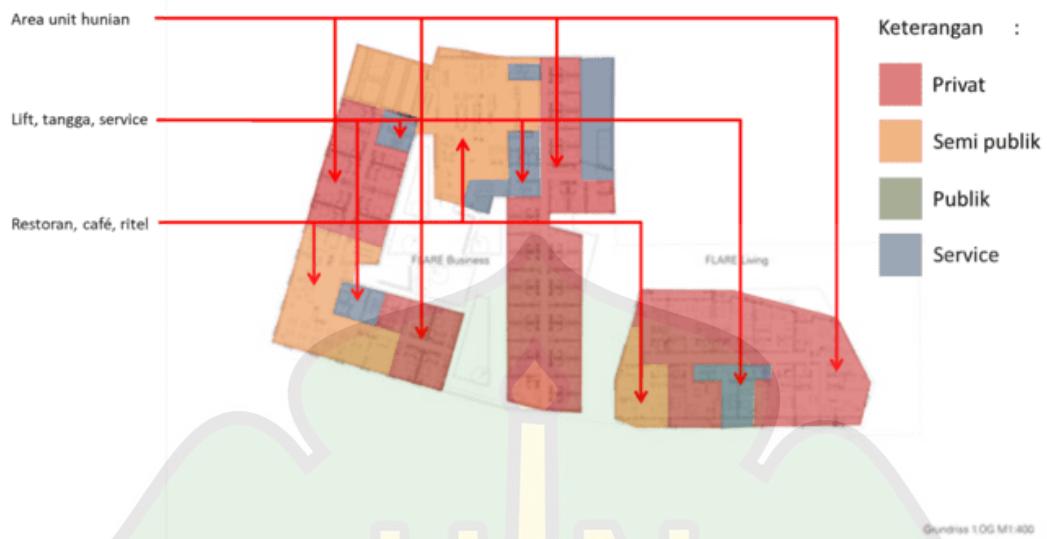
Analisis ruang pada denah lantai dasar Flare of Frankfurt
